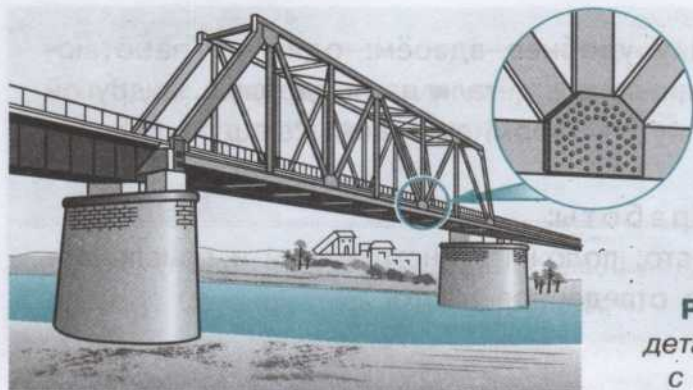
Соединение деталей моста заклёпками с полукруглой головкой
